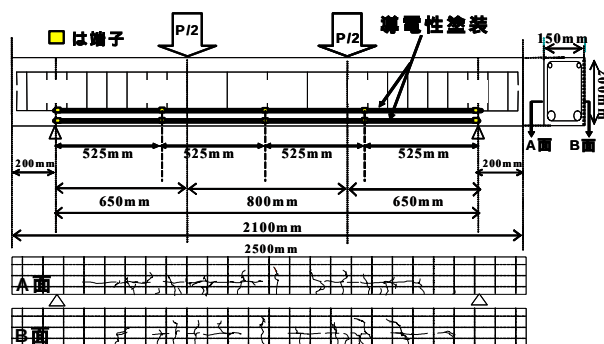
梁試験体塗装箇所と測定時のひび割れ
